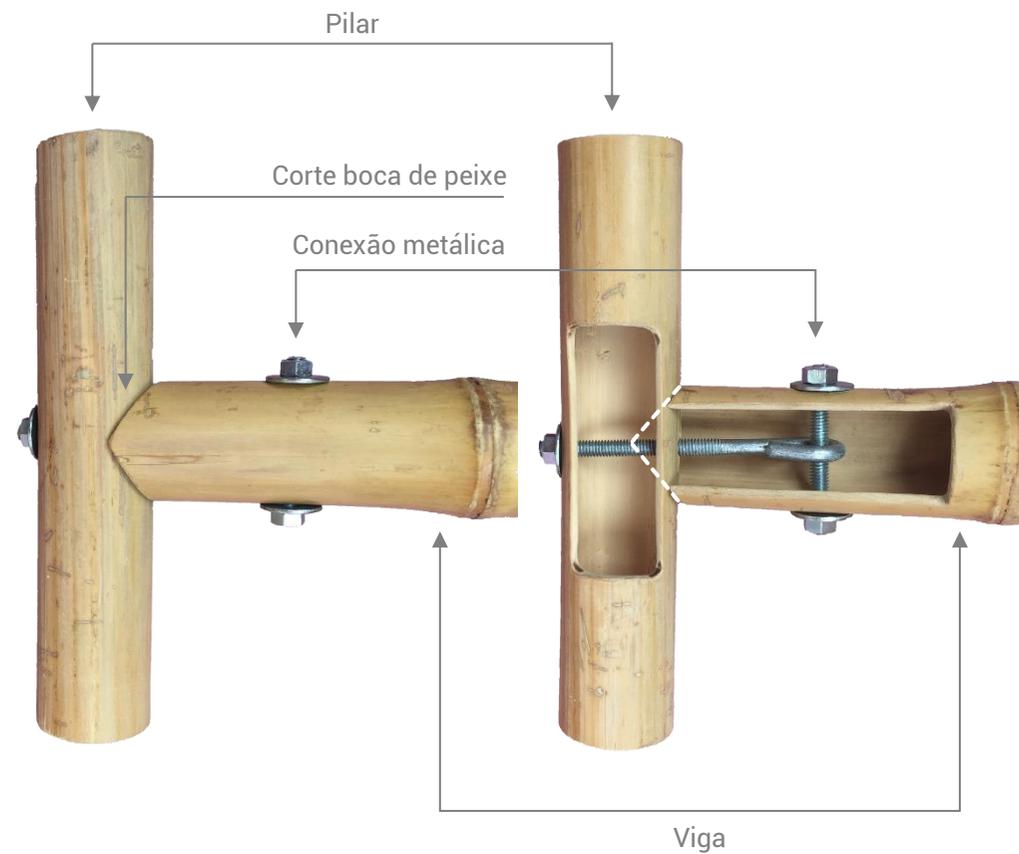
Protótipo (em corte) da conexão metálica entre as vigas de travamento e os pilares.
